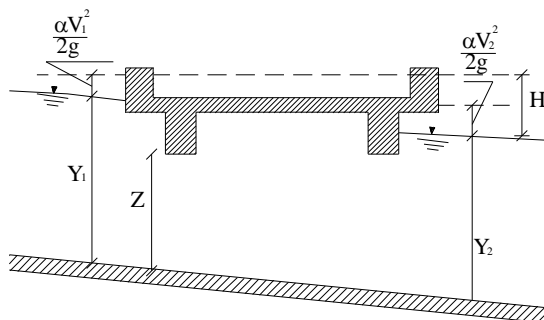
Sezione schematica di un ponte – Schema di calcolo
